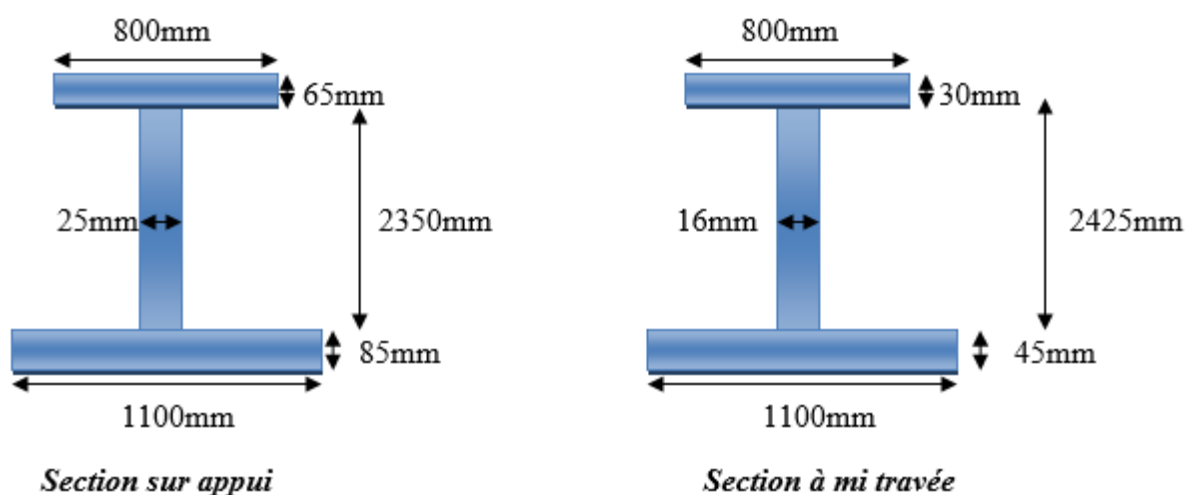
PRS à gauche (section sur appuis), à droite (section à mi- travée).
